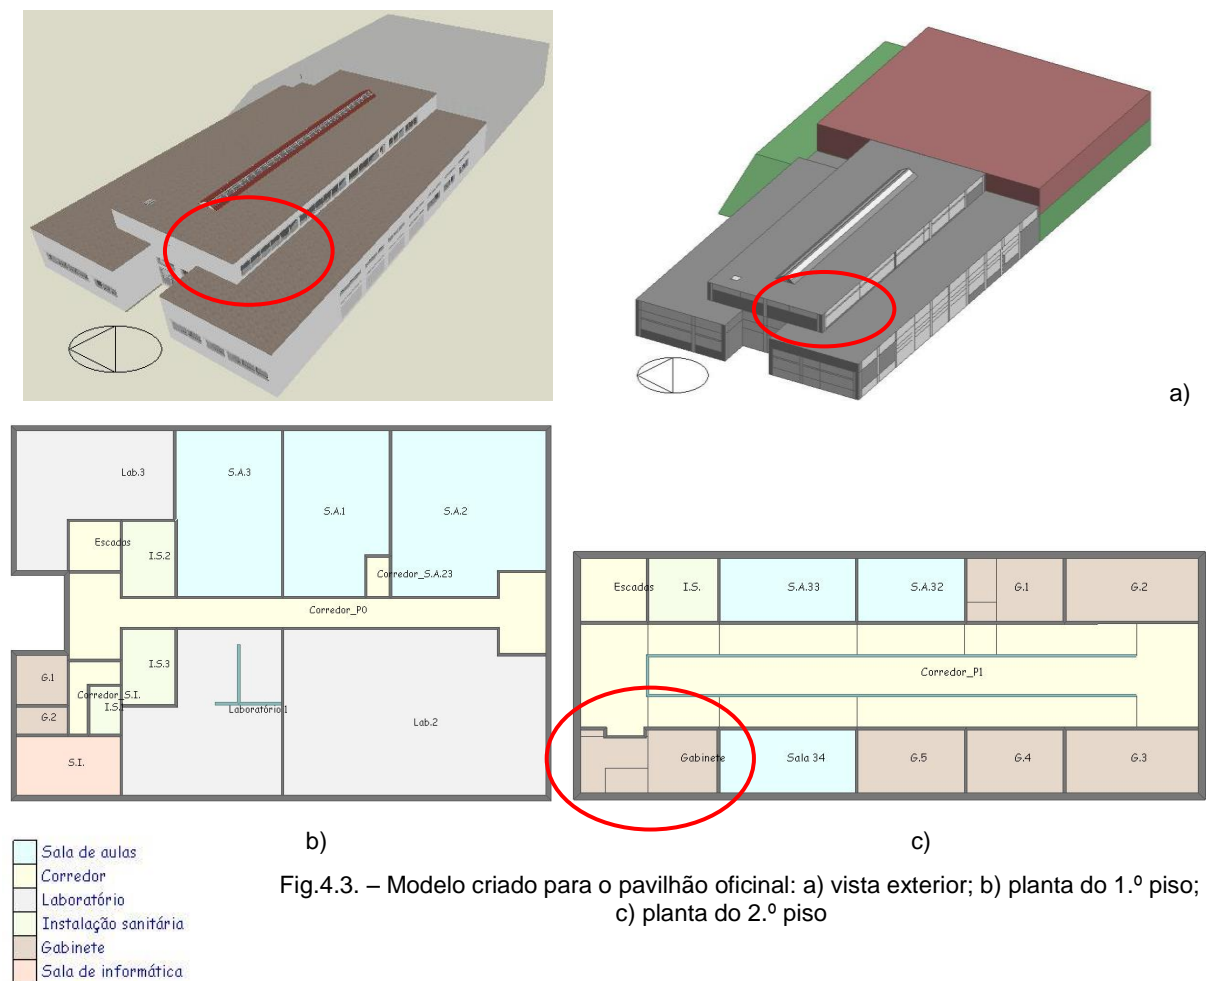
Modelo criado para o pavilhão oficial: a) vista exterior; b) planta do 1.º piso; c) planta do 2.º piso
